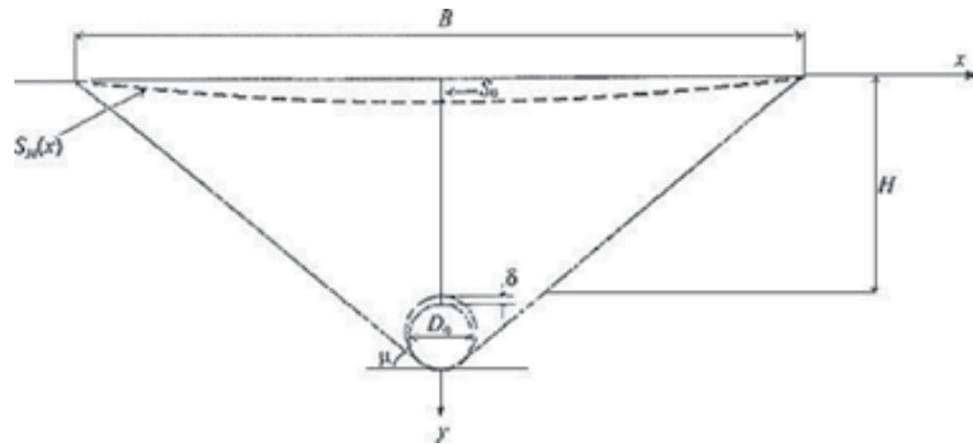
Пример расчетной схемы деформирования основания над тоннелем [2]
